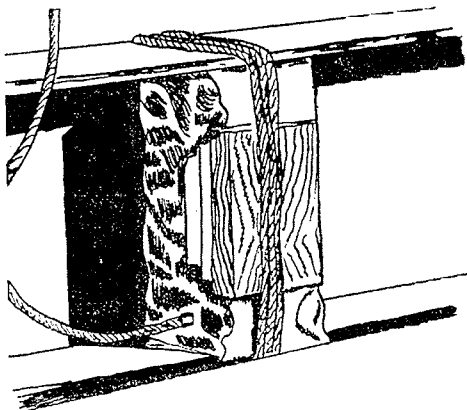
Adaptación del explosivo plástico a un perfil laminado
